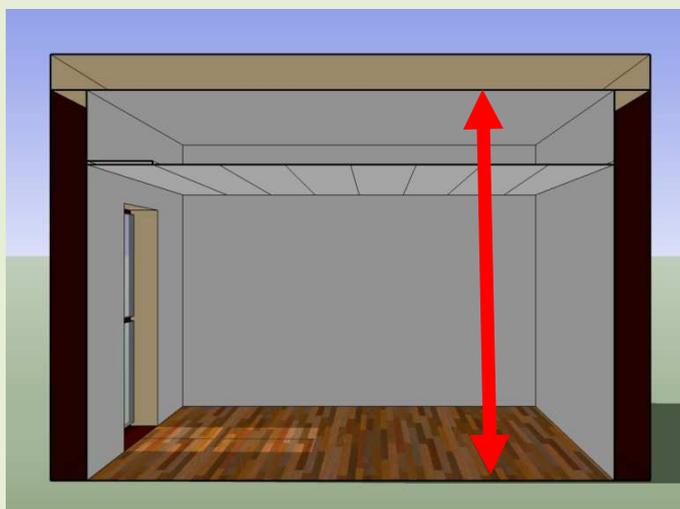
Evidenziazione dell'altezza netta con controsoffitto aperto ispezionabile.
